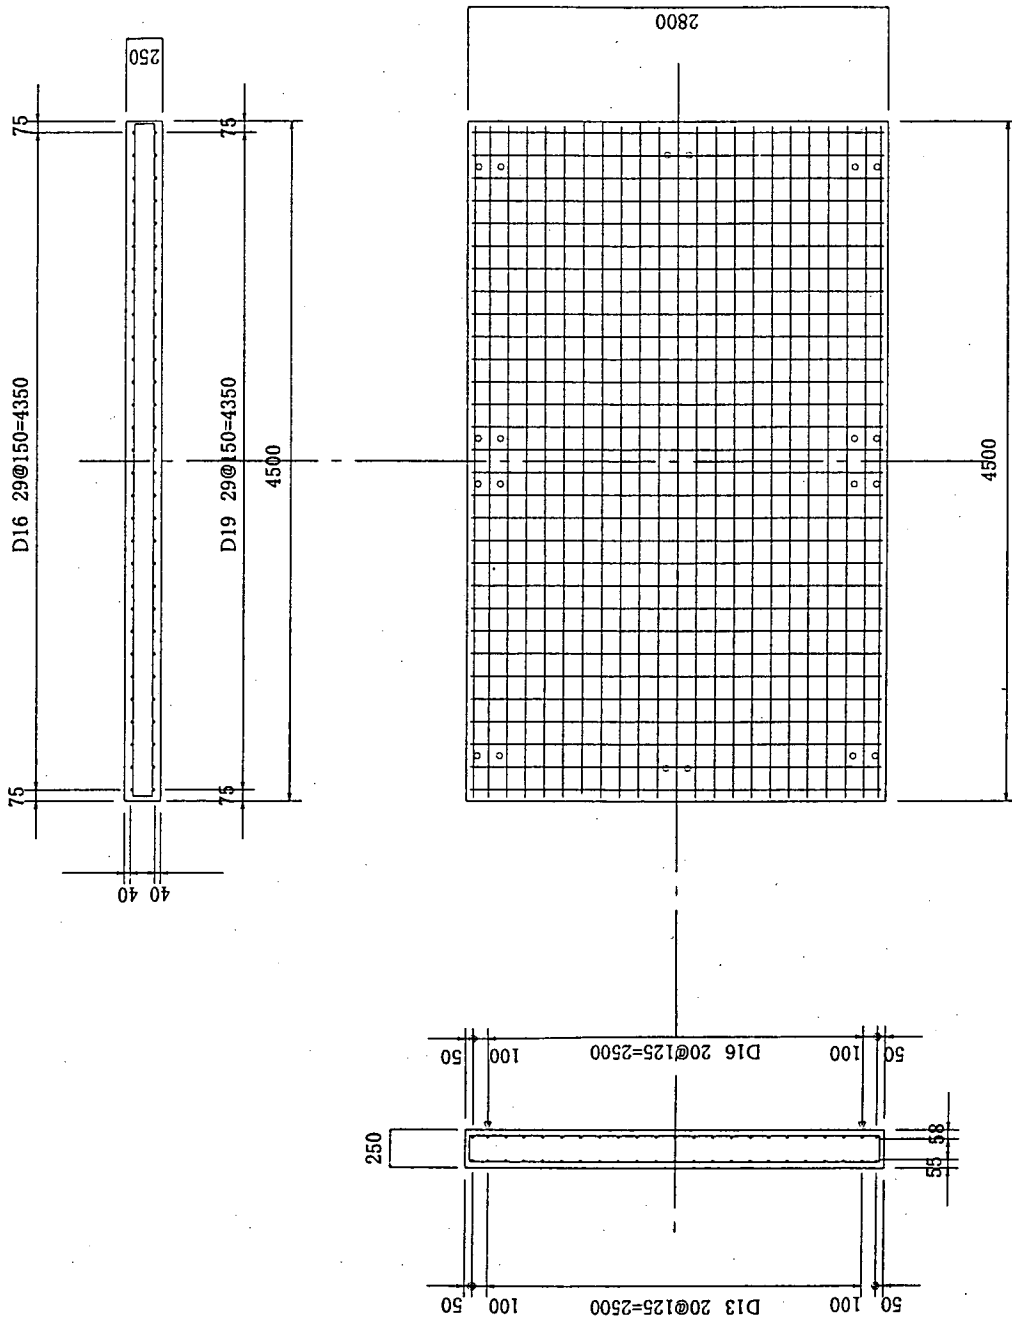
RC80供試体の形状・寸法 (単位:mm)
